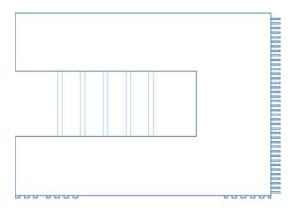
Imagen de autoría propia que muestra la inserción de planos seriados en planta.
